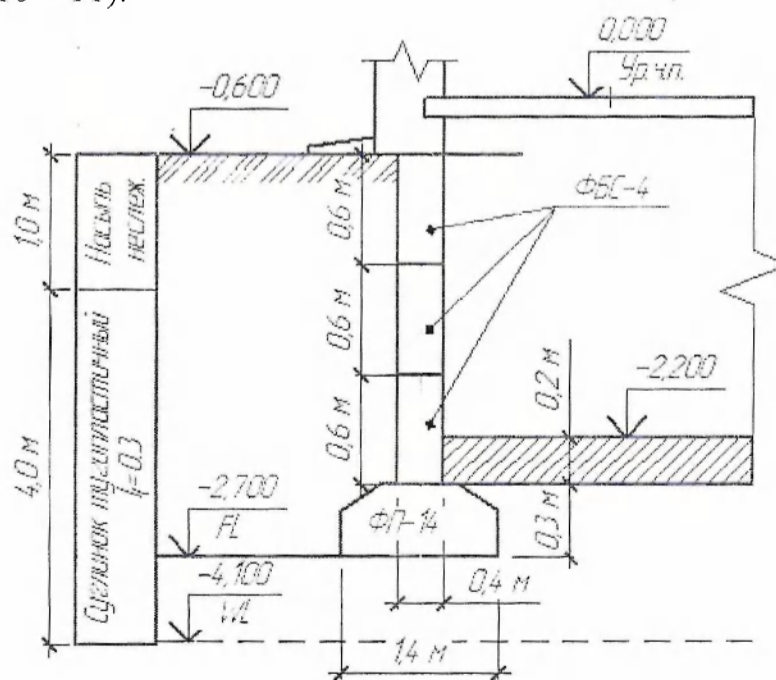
Изображения конструкций фундаментов. Фрагмент сборного ленточного фундамента.
